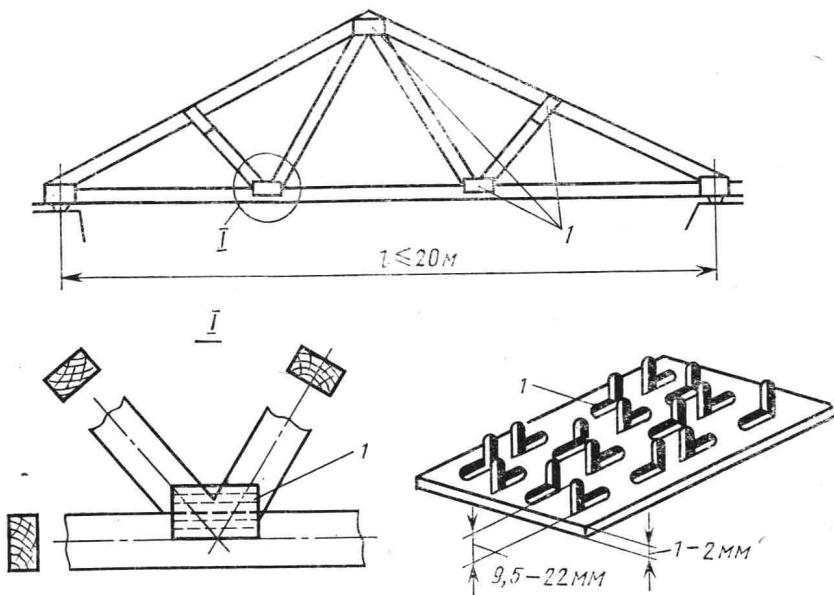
Ферма из досок с узловыми соединениями на гвоздевых пластинах «ГЭНГ-НЭИЛ»:
